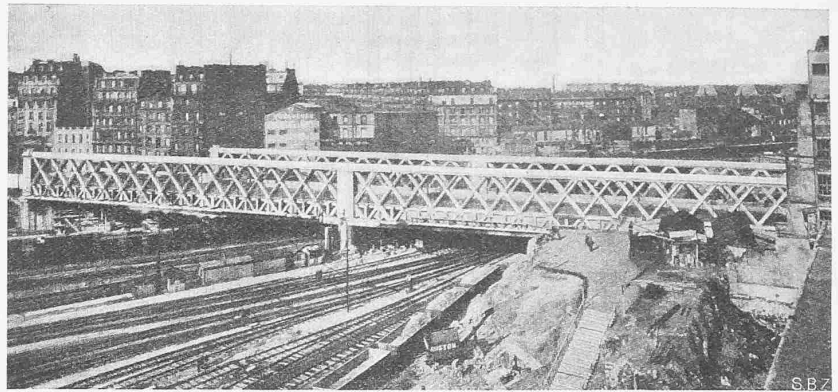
Ueberführung der Rue Lafayette: Eisenbeton-Fachwerk, Trägerhöhe 10,40 m.
